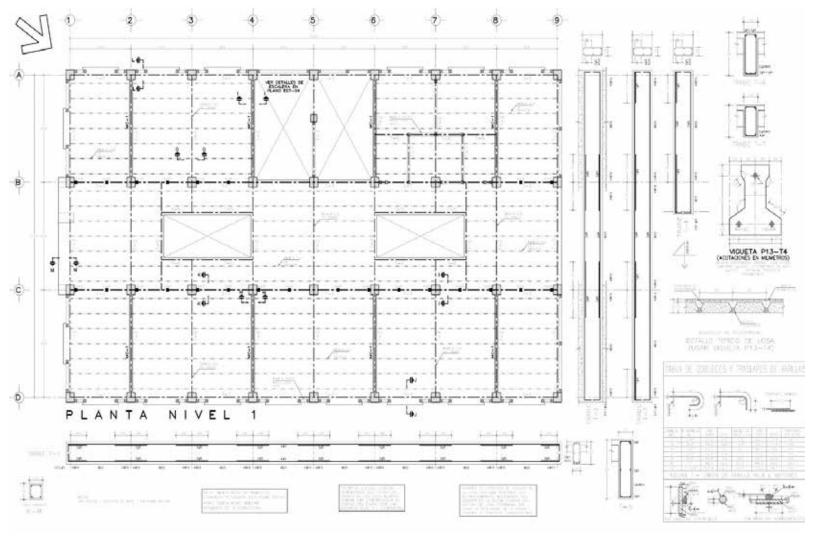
Planta de armado de losa o azotea (Dependiendo del tipo de losa)
